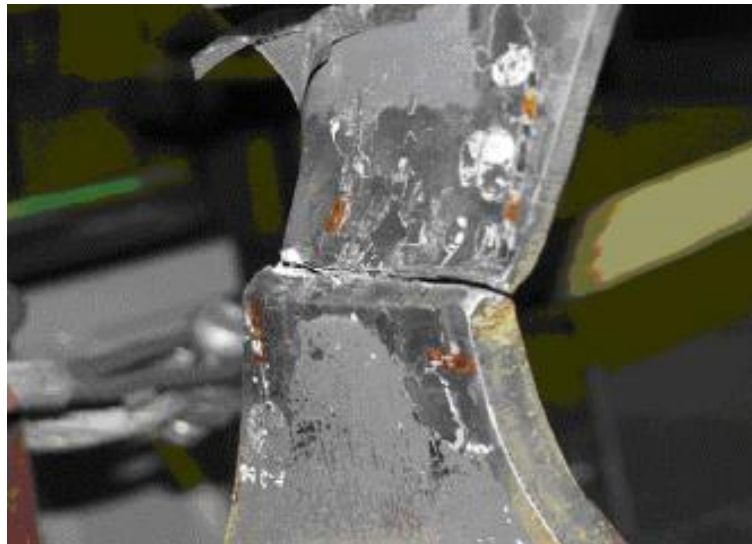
Ruptura de la soldadura en el montante del alma.
